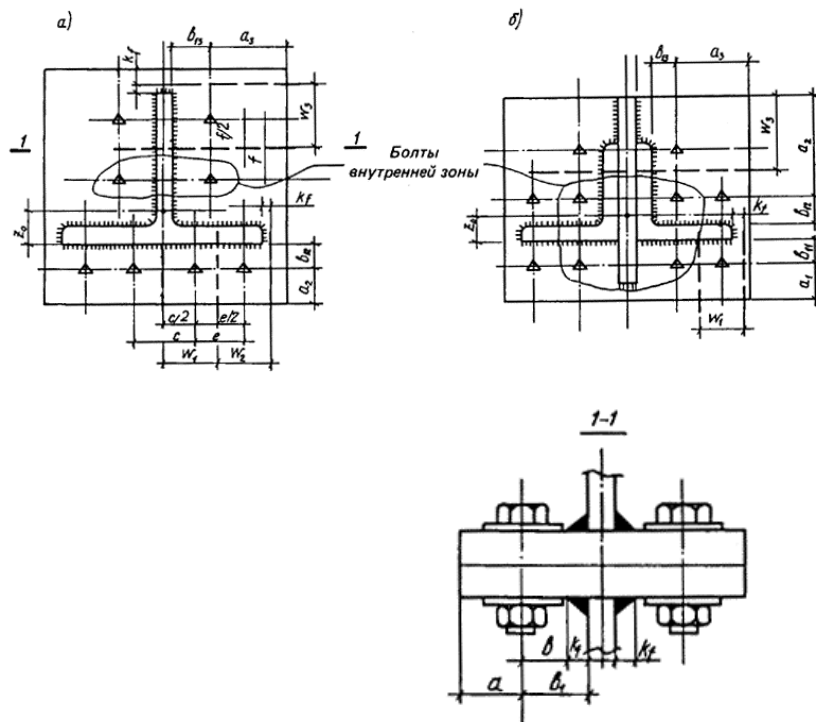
Схема фланцевых соединений стропильных ферм с поясами
